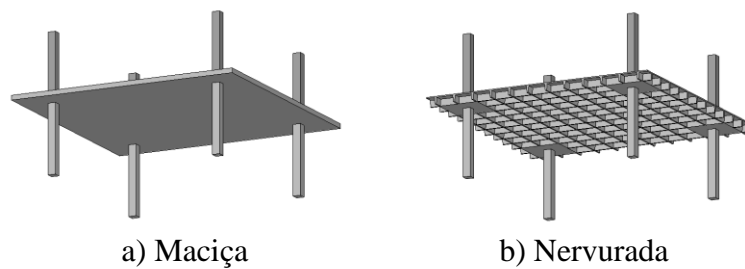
Lajes lisas [adaptado – FERREIRA (2010)]
